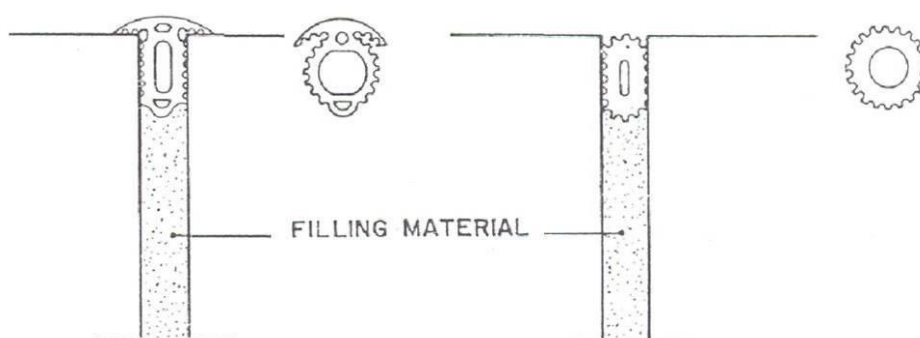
รายละเอียดและระยะต่างๆ ของ Open-drained Joints ที่พัฒนาจากแบบทดลองในยุคแรกของ Building Research Station และนิยมใช้กันในตอนหลัง
